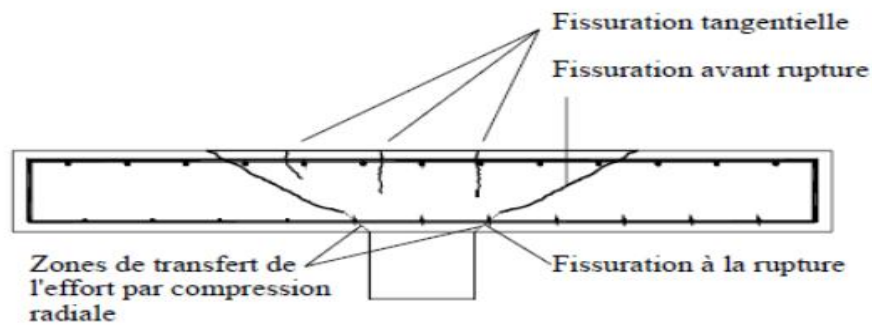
Fissuration lors d'une rupture par poinçonnement [25]
